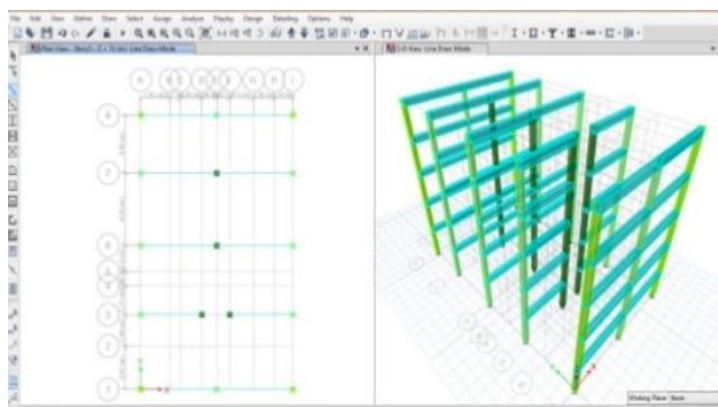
Vista en planta y 3D de los elementos dibujados (Vigas y columnas).
